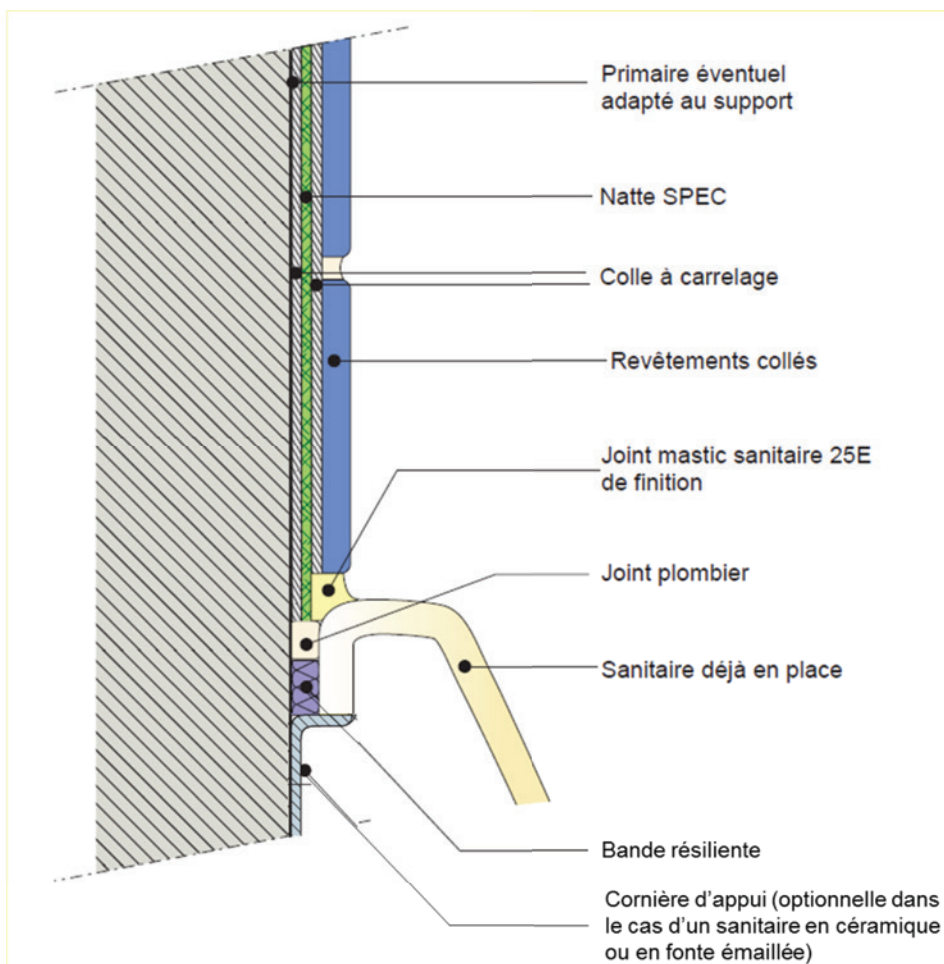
Raccordement du sanitaire à la paroi ; cas d'un sanitaire en acrylique
